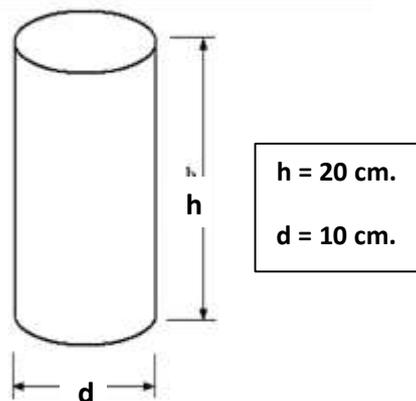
Forma y Dimensiones de la Probeta 10*20 cm.
